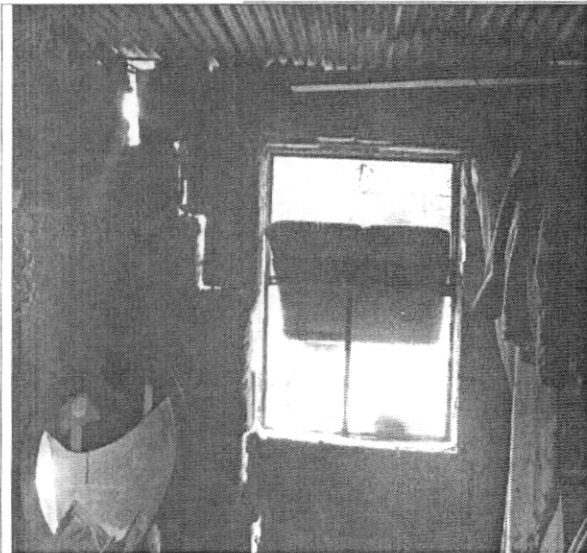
Detalle interior de grietas parte posterior, grietas aproximadamente de 5 a 9 cms. de abertura
